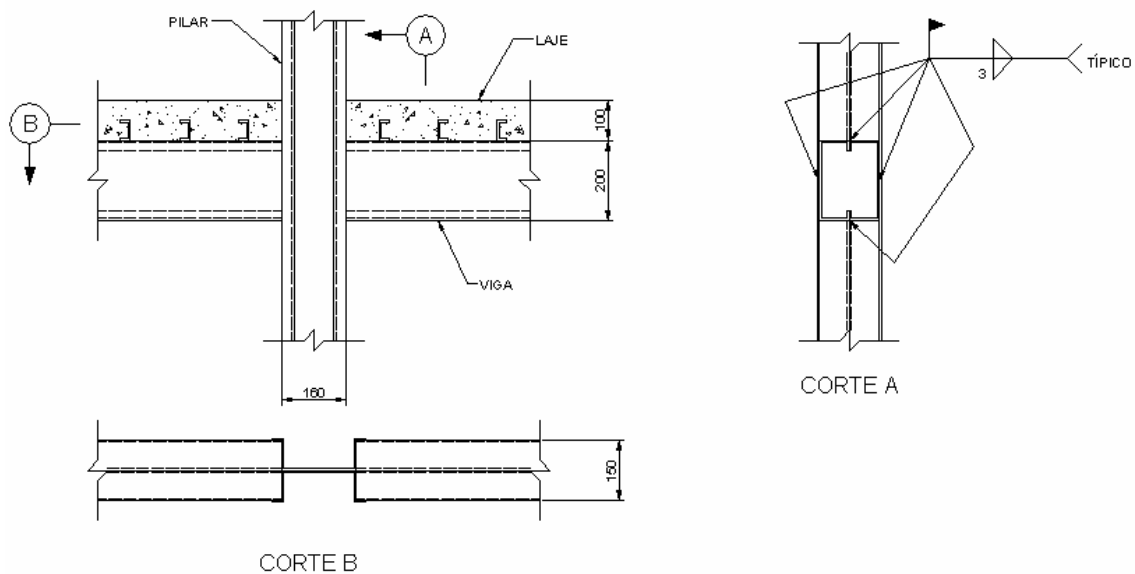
Detalhe construtivo da ligação Viga – Pilar na direcção y [3]
